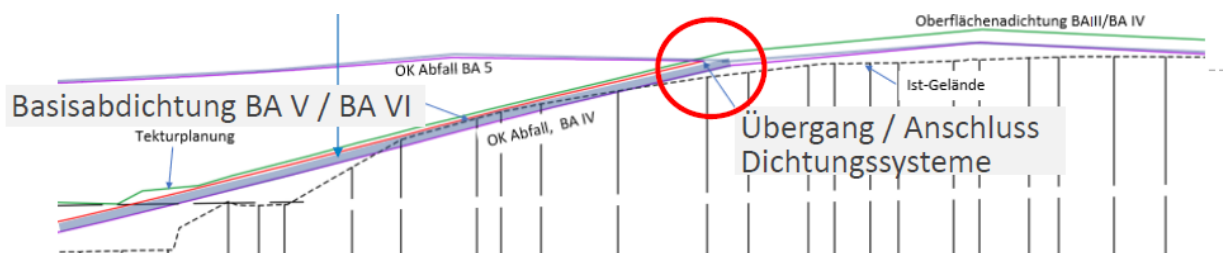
Lage Übergang / Anschluss Dichtungssysteme obere Böschung überlagerte Bestandsdeponie
